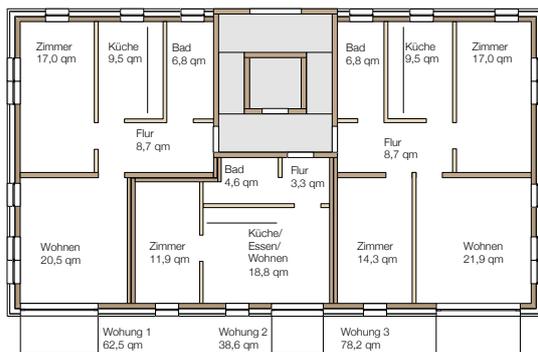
Grundrisskonzept mit Innenliegendem Treppen kern
